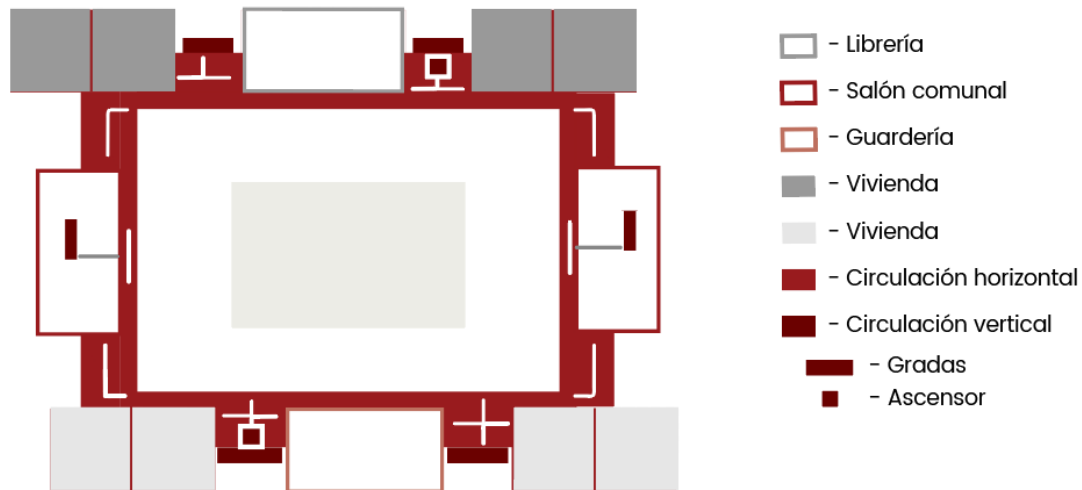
Diagrama primera Planta Alta. Elaboración propia.
